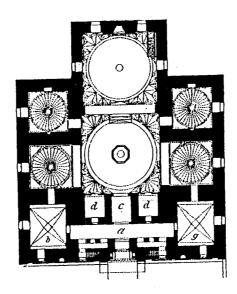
مسقط أفقي لجامع السلطان أحمد الأول باستانبول (عن: Goodwin).
